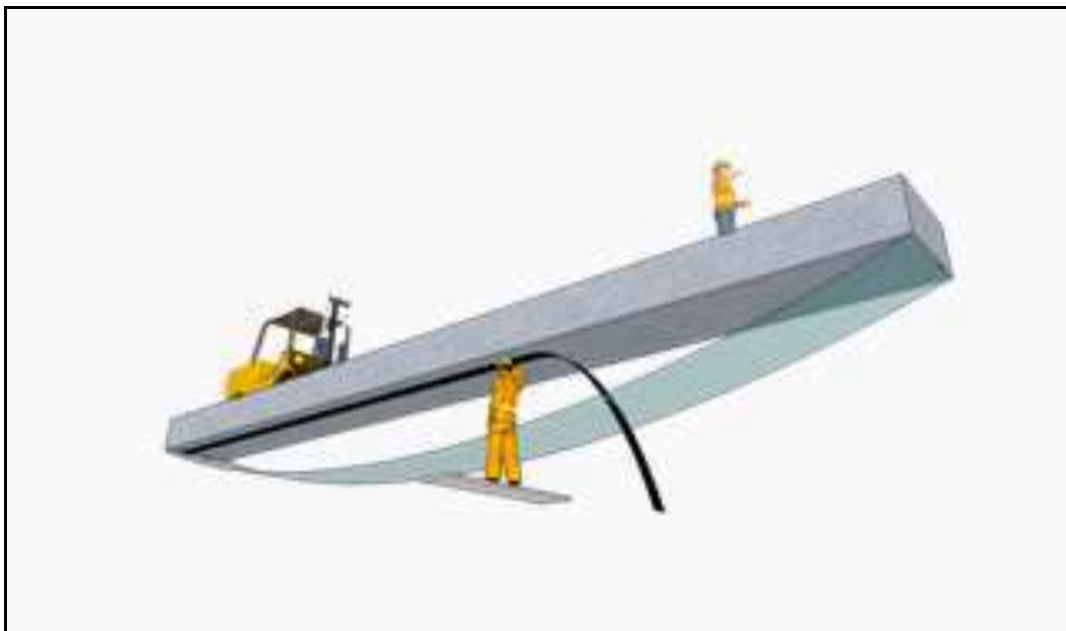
Acero de refuerzo requerido para cada una de las vigas del puente
